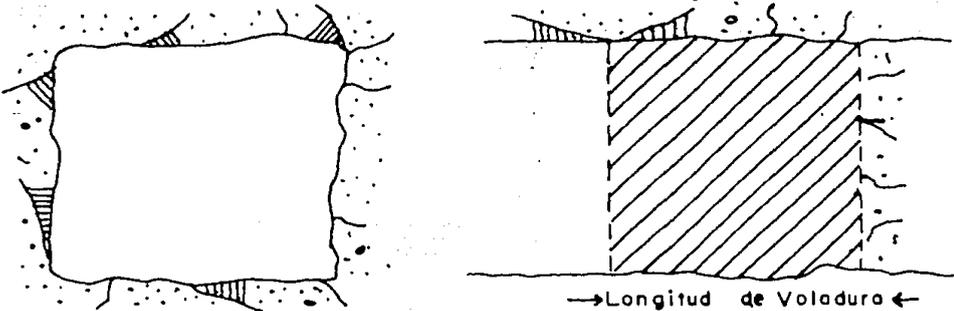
Sección Transversal y Longitudinal de Túnel.
